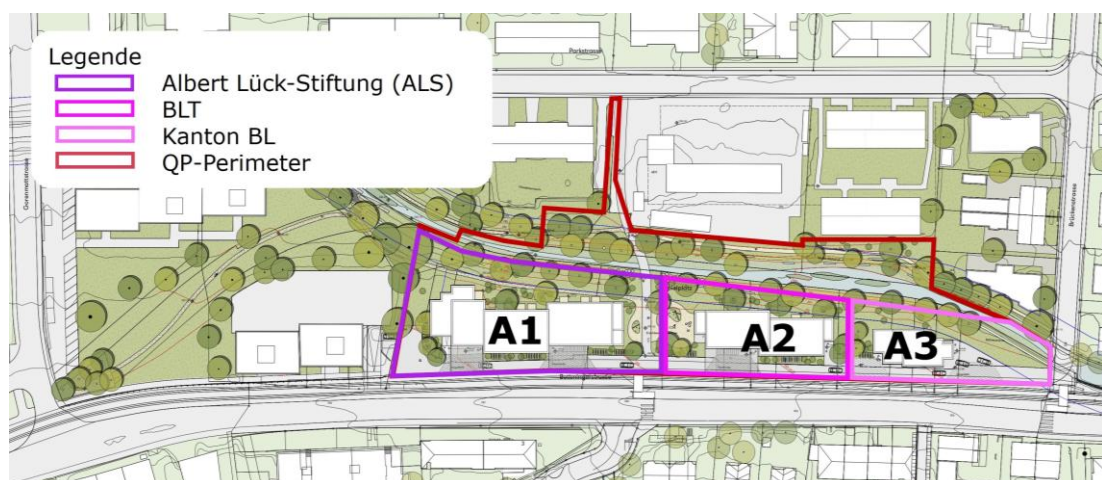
Ausschnitt Quartierplan Spiesshöfli mit den geplanten Gebäuden
